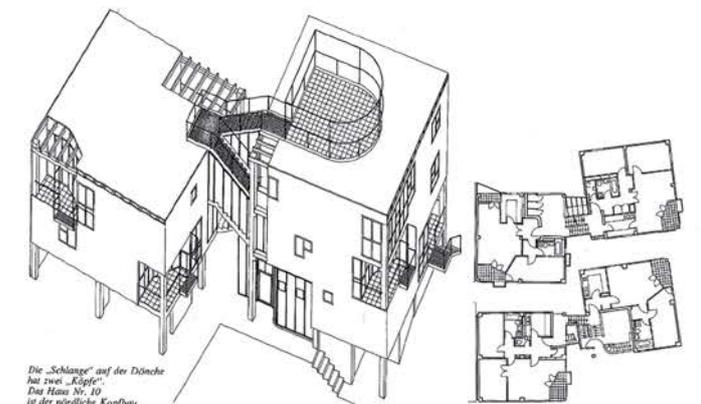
axonometrische Darstellung und Grundrisse des Hauses Nr. 10 von Steidle, 1982
